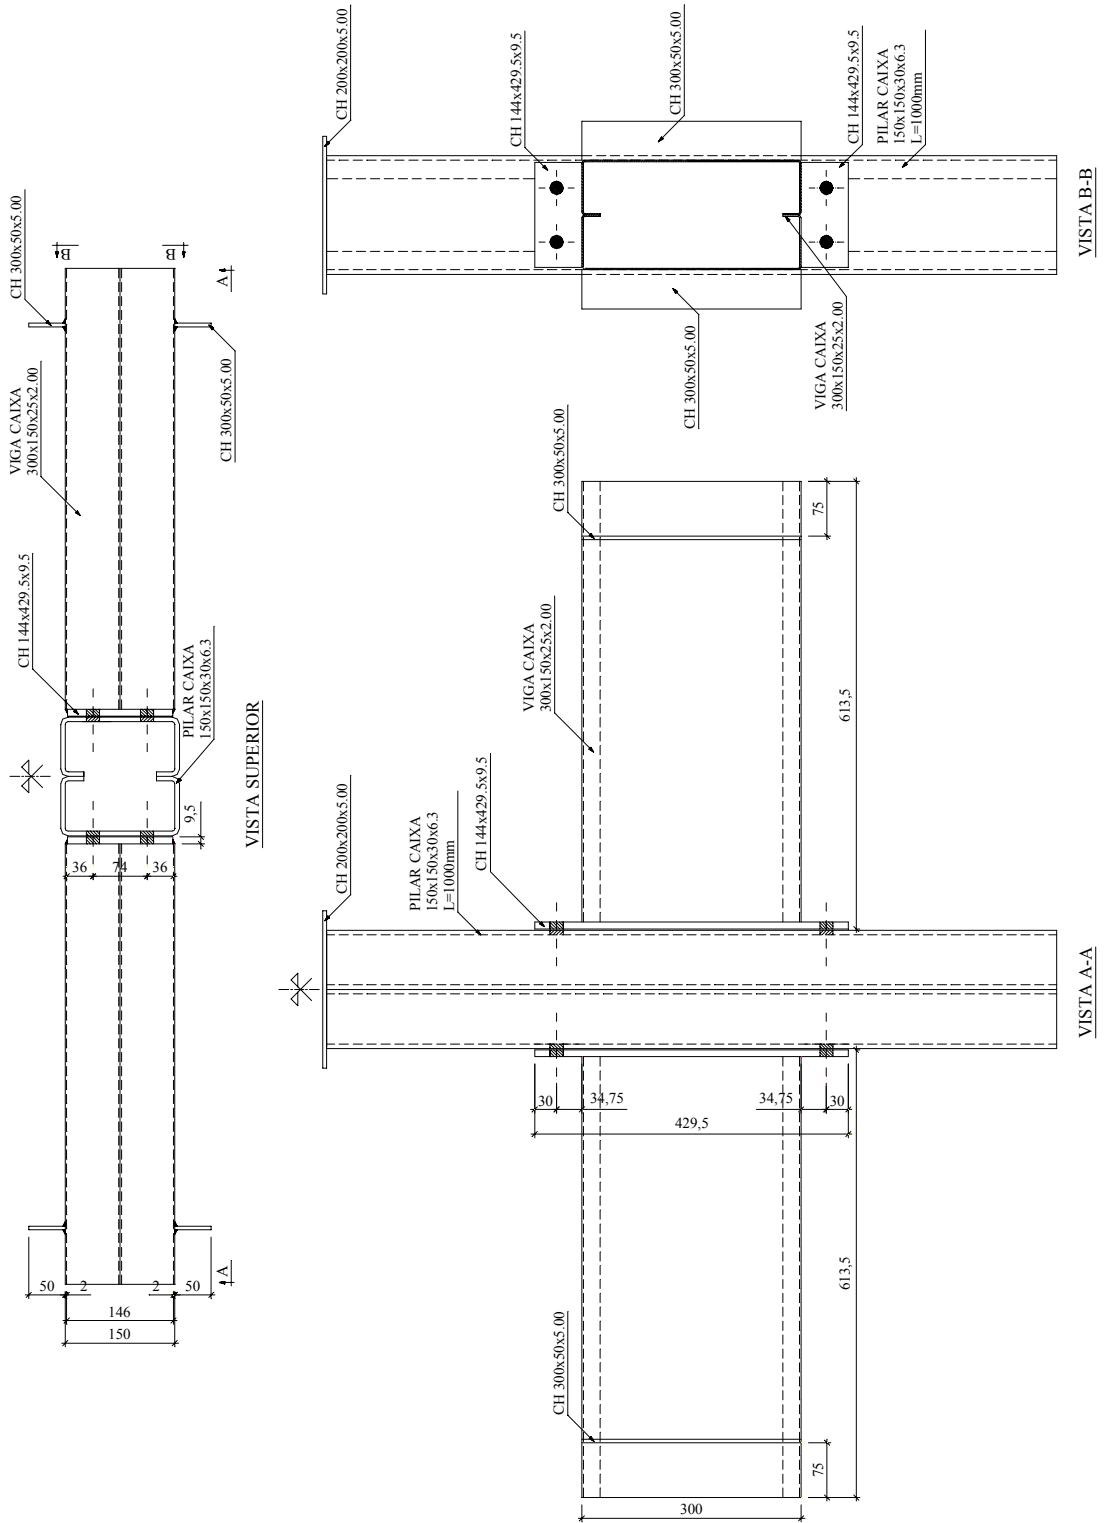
Ligação 04AF: flexível na menor inércia do pilar.
